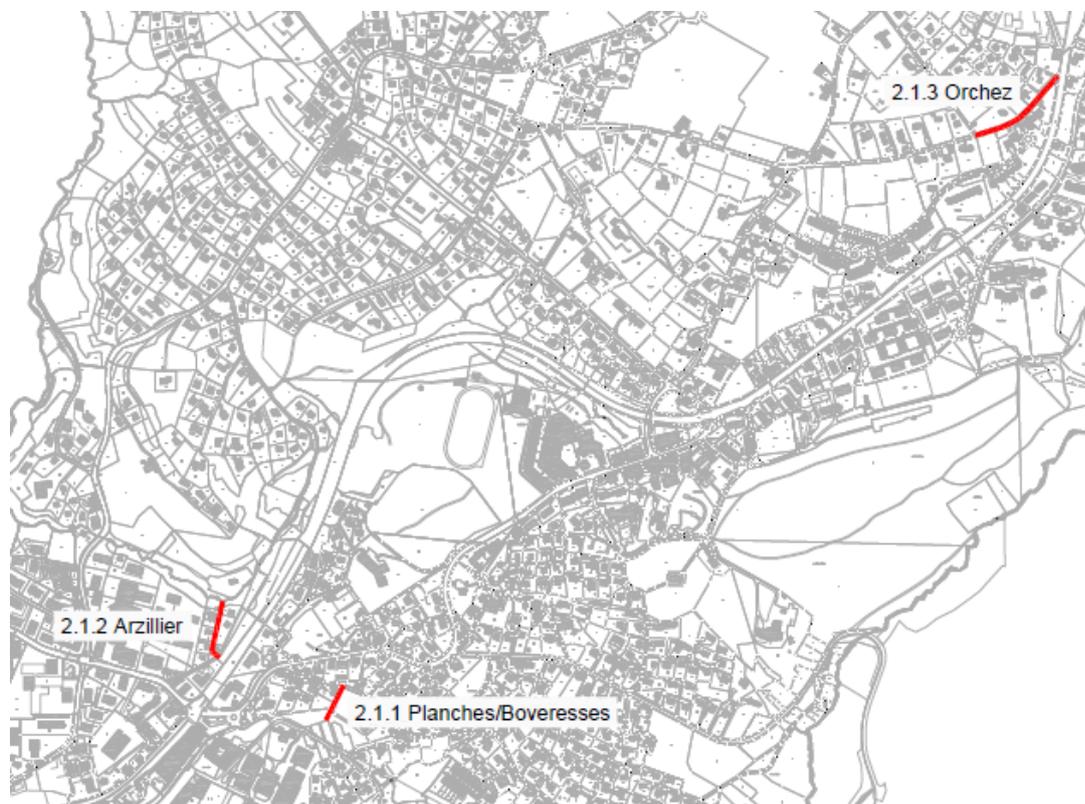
Plan de situation avec les collecteurs faisant l'objet du présent préavis
